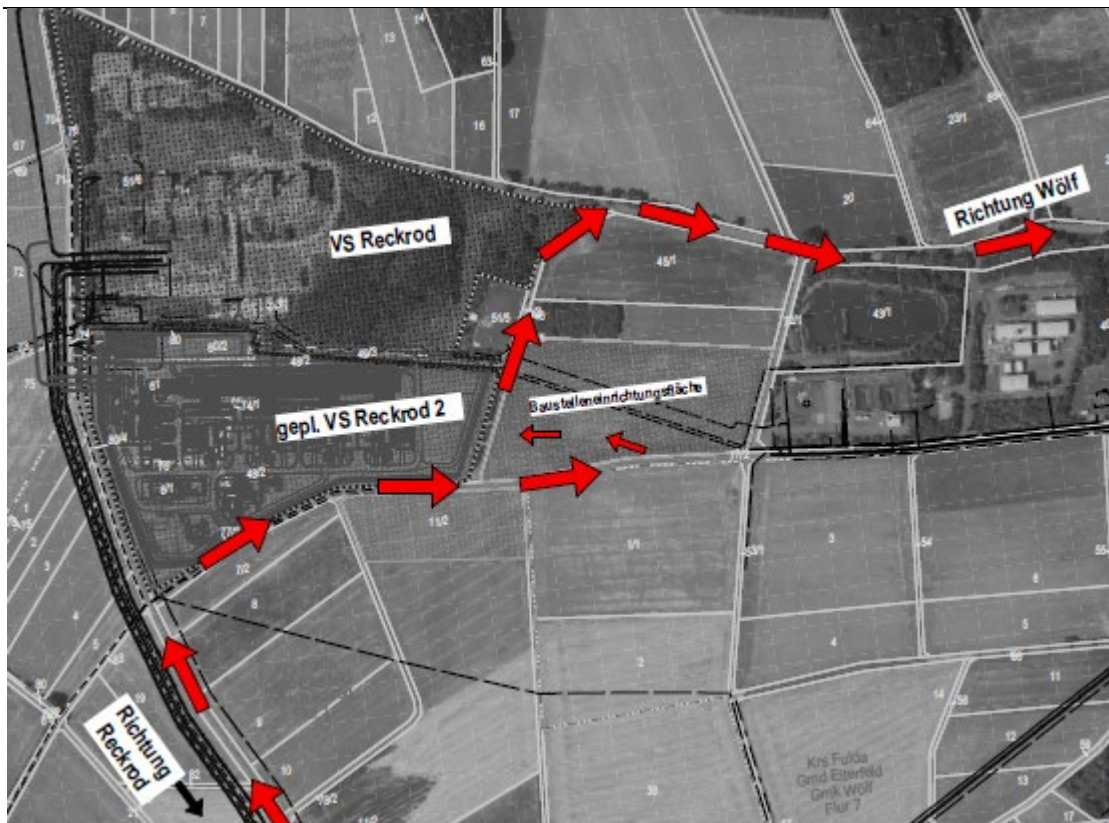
Hauptsächliche LKW-An- und Abfahrt zur Baustelle, Bereich VS Reckrod 2
